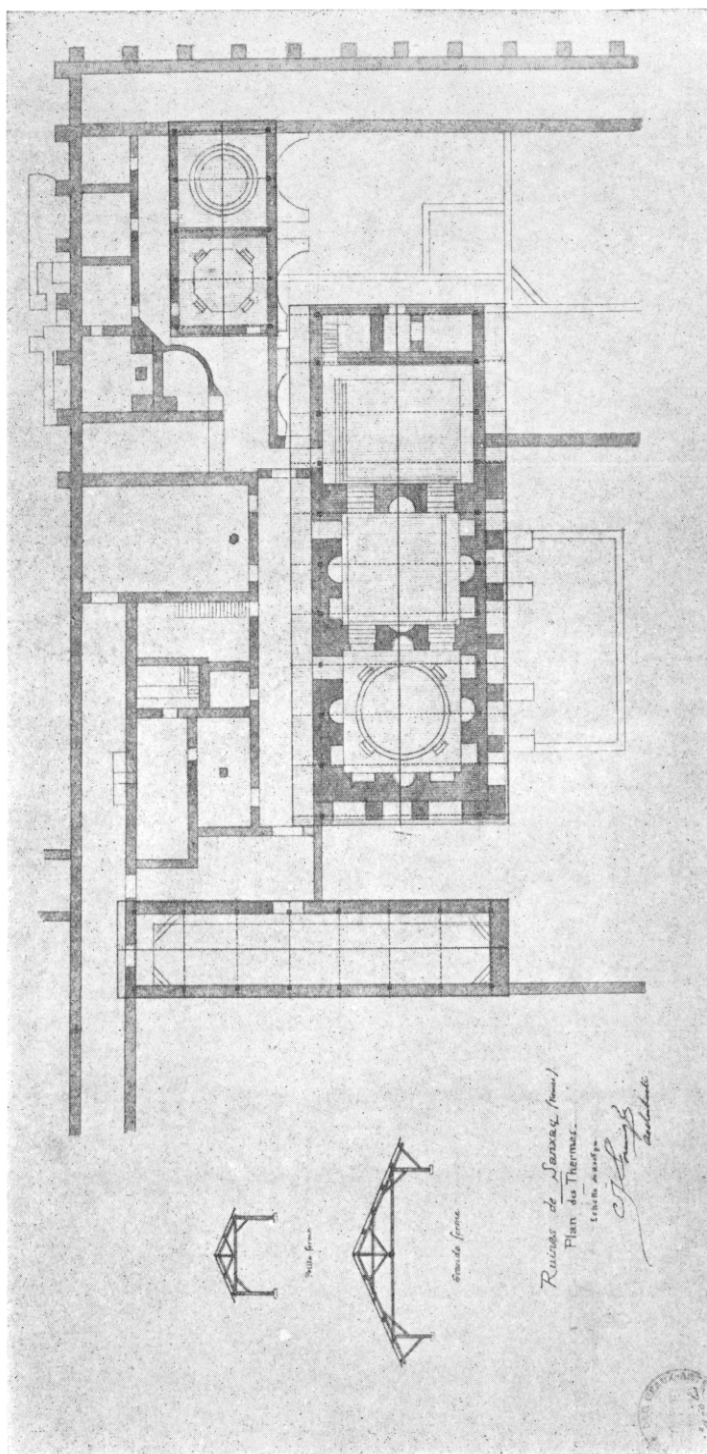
Plan du dernier état des thermes. (Plan de C.-J. Formigé.)
